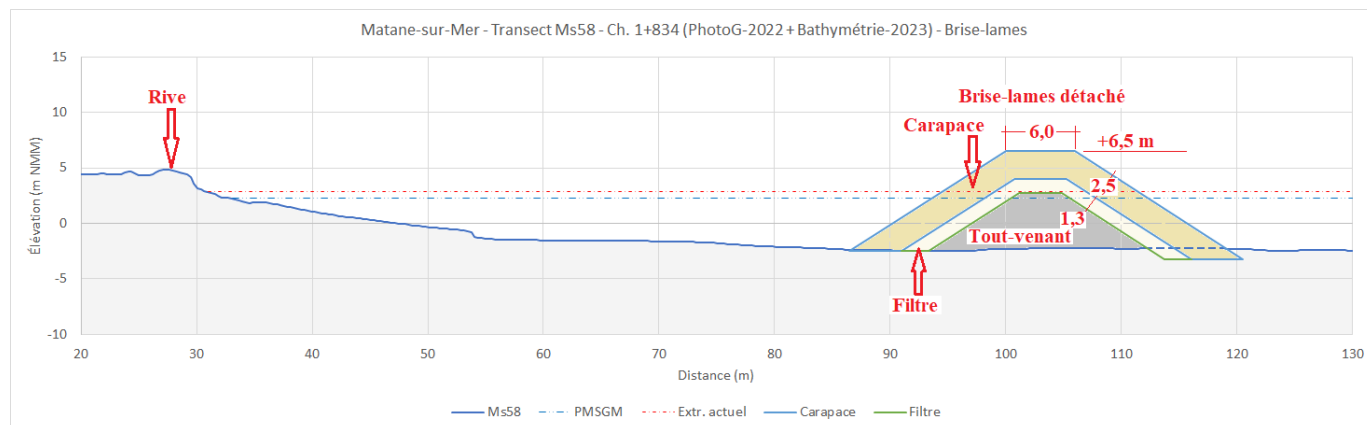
Coupe-type d'un brise-lames détaché à 75 m de la rive – Matane-sur-Mer
